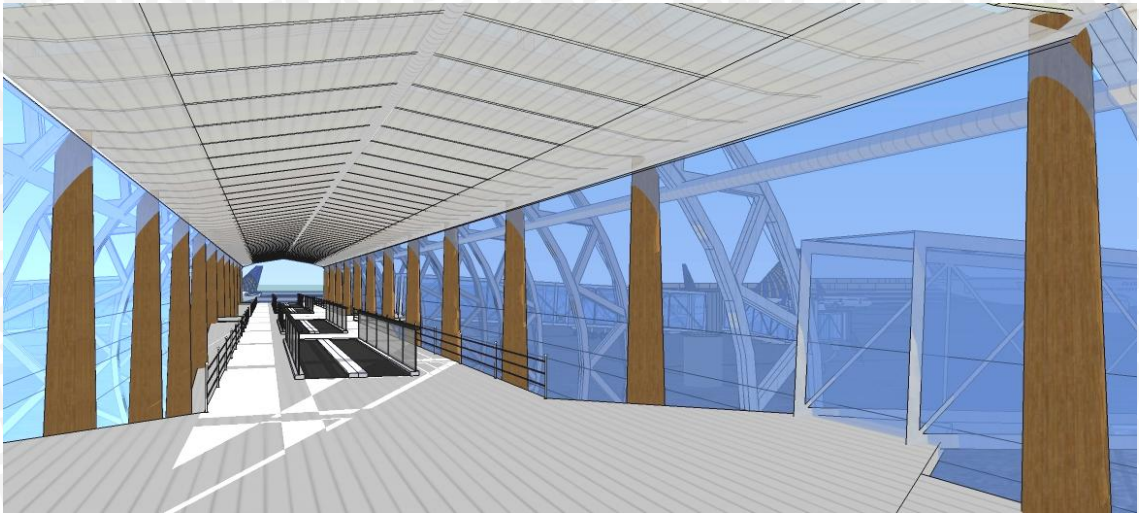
Perspektif bangunan terminal penumpang zona udara
